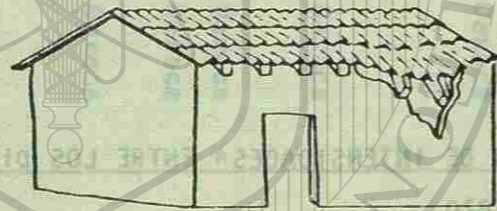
Falla local por empuje de las vigas en muros de piedra y lodo
